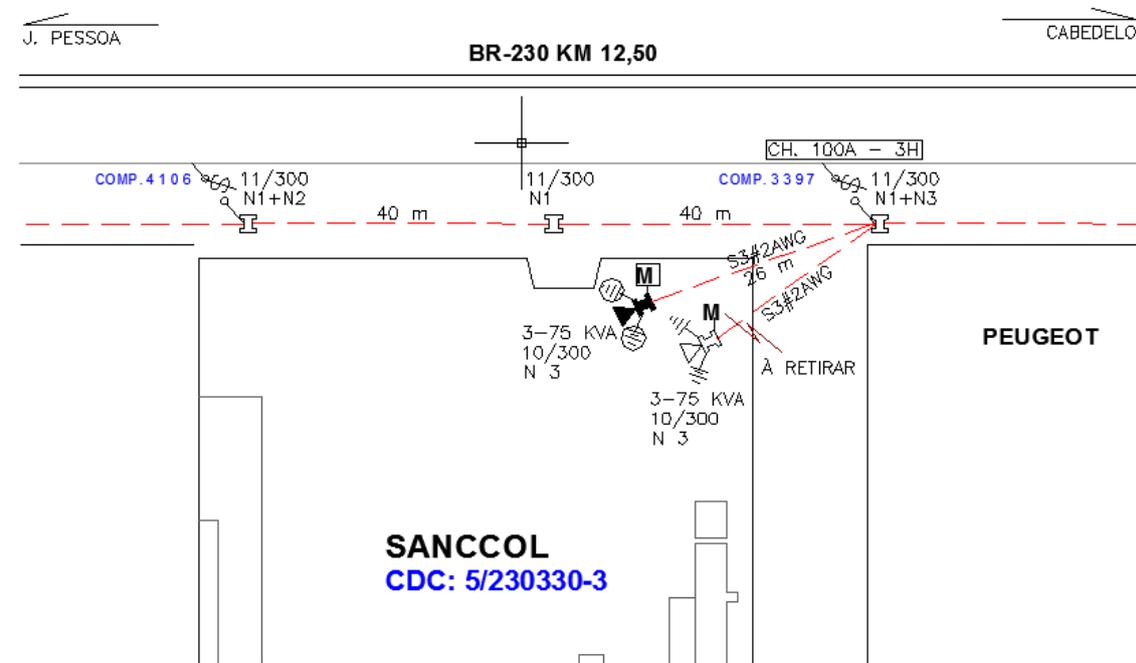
Planta de Situação para a Subestação de 75 kVA da Sanccol. [Fonte: Da Autora]
